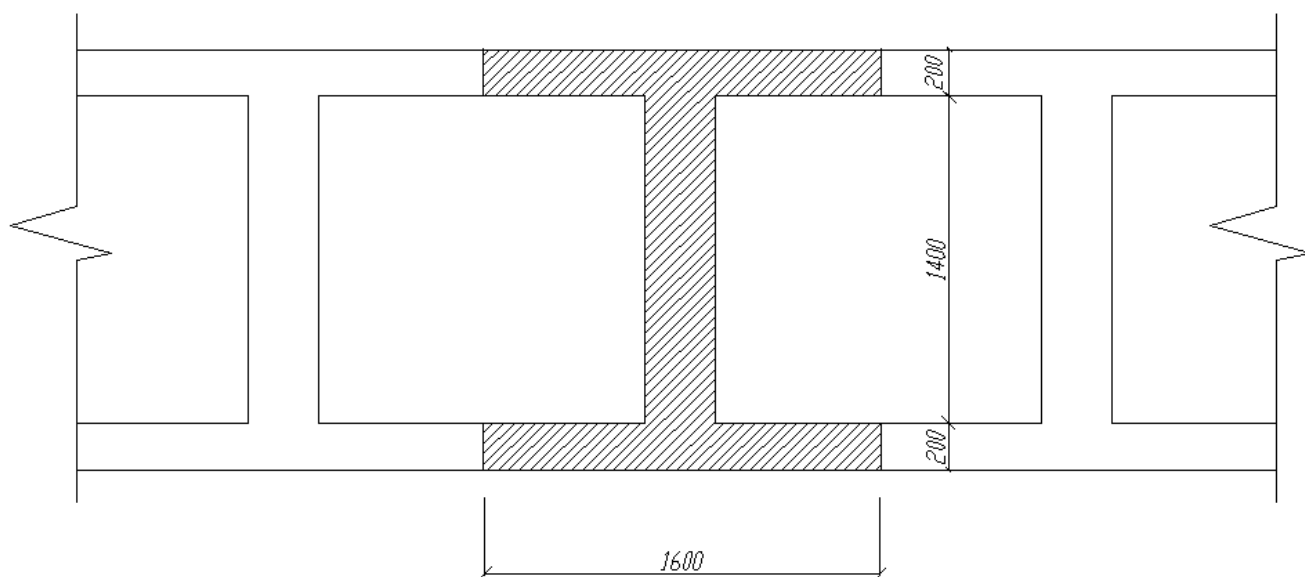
Поперечний переріз вирізаної ділянки фундаменту
